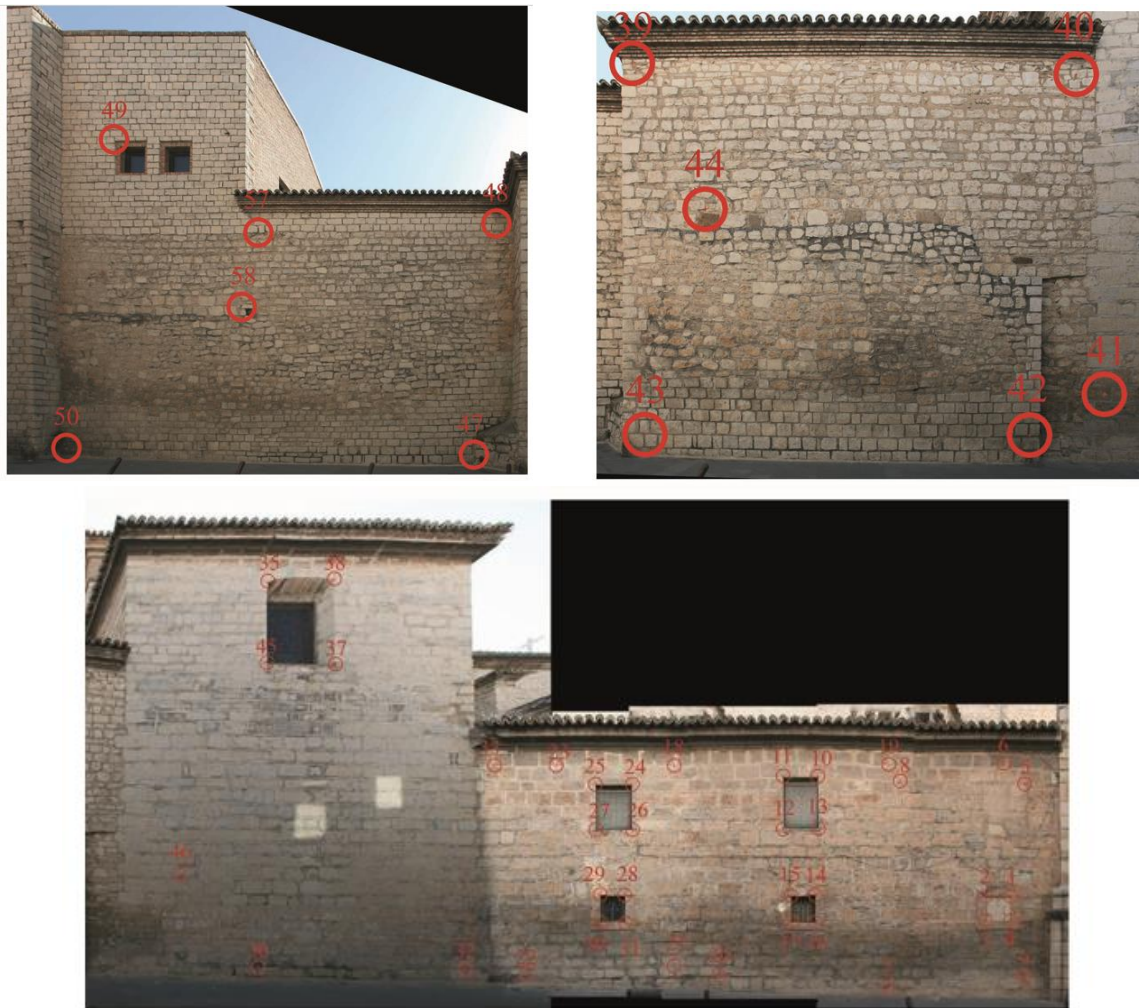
Croquis de distribución de los puntos de apoyo en la fachada del convento
